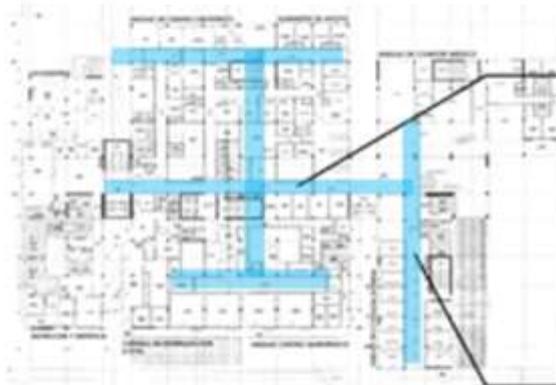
y 04: Vistas de Corredores. Plano: PLANTA MUROS y TABIQUES DE ALBAÑILERIA SEGUNDO NIVEL (foto 726)
